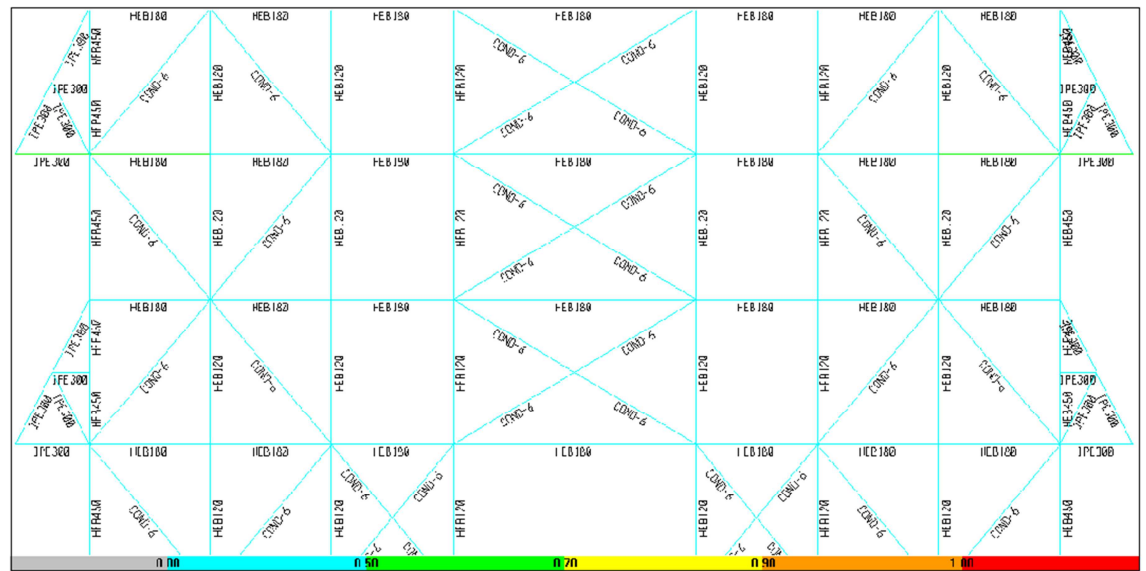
Análisis de los voladizos de entradas de aire bajo las solicitaciones de carga.
